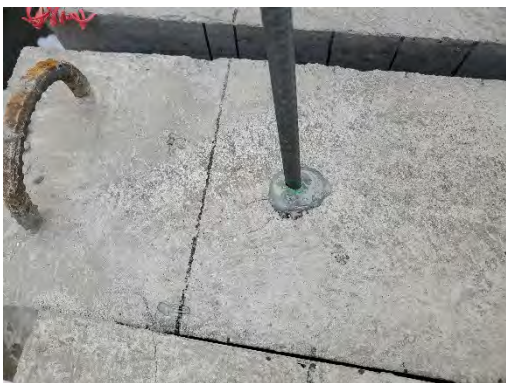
(4)-2 接着系あと施工アンカーの施工状況 (1/5)
